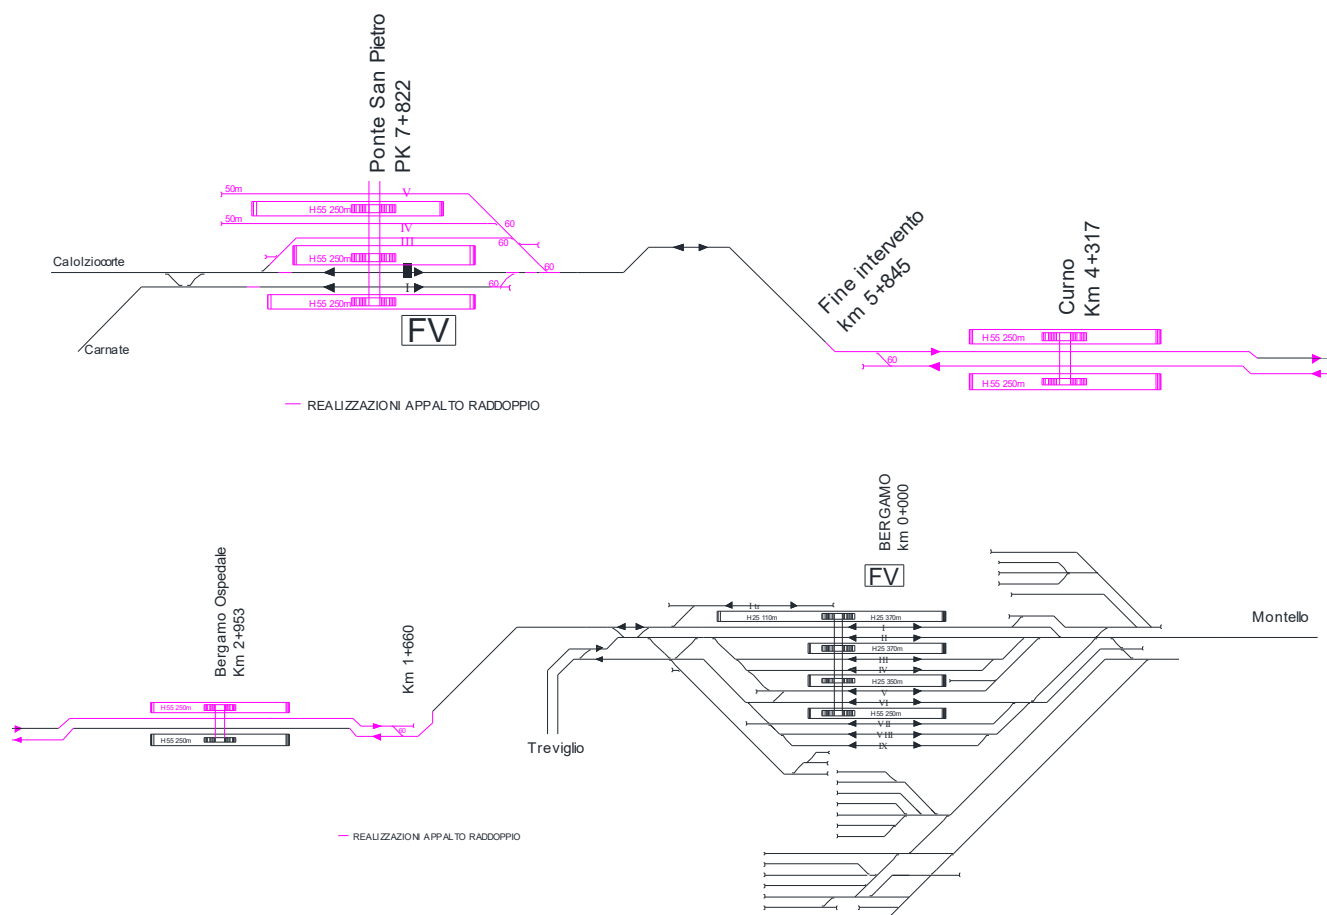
Layout funzionale della situazione di riferimento iniziale, ossia realizzazione del Raddoppio tra Ponte San Pietro e Bergamo (in fucsia)
